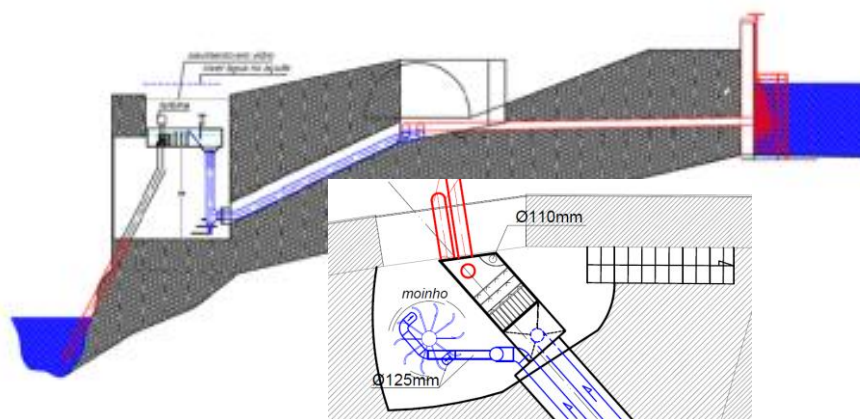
Corte transversal do terreno e detalhe da vista superior do dique, tubagem e galeria com a roda de água horizontal do moinho e turbina.
